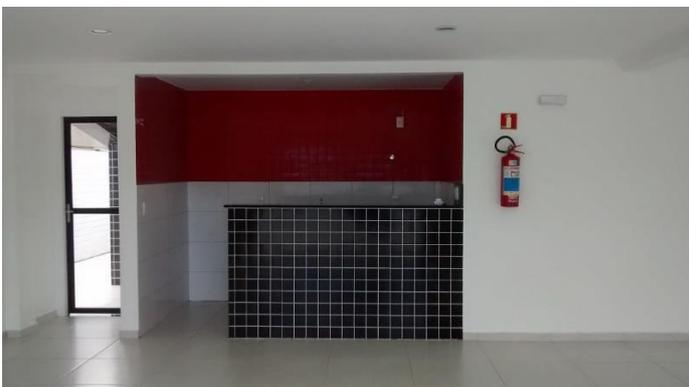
S. de festas executado – Ed. Dulce Tenório
